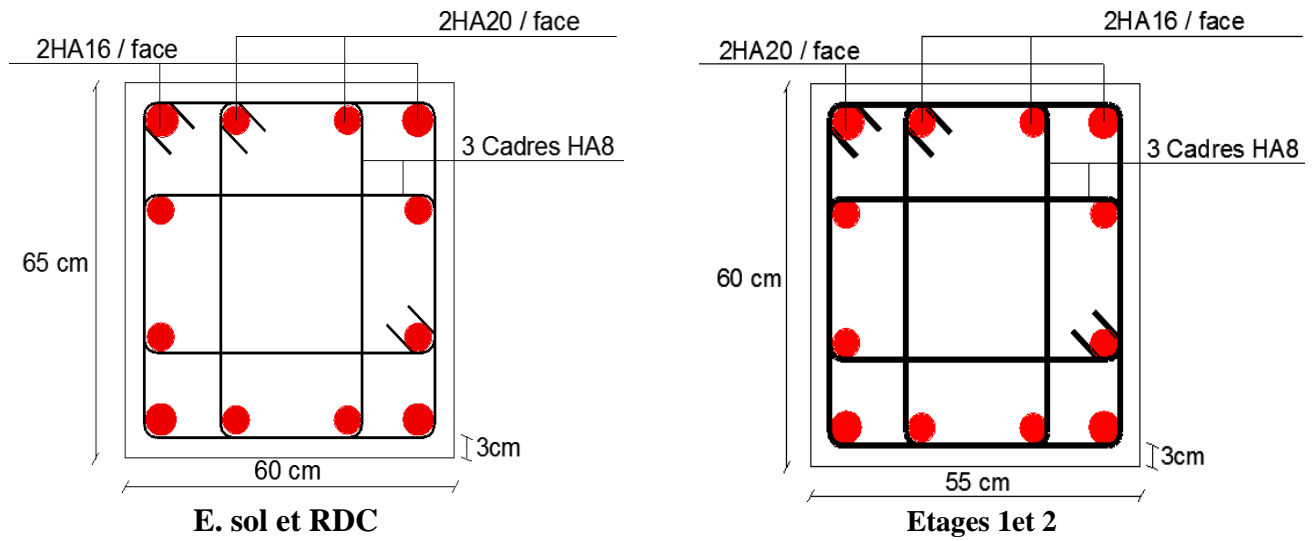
Schéma de ferrailage des poteaux du E. sol, RDC et étage 1 et 2.
